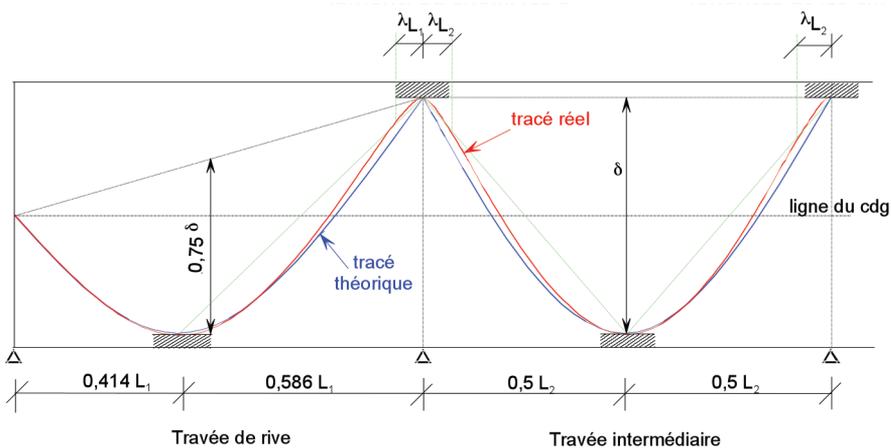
• Exemple de tracé parabolique des câbles, travée de rive, travée intermédiaire.
